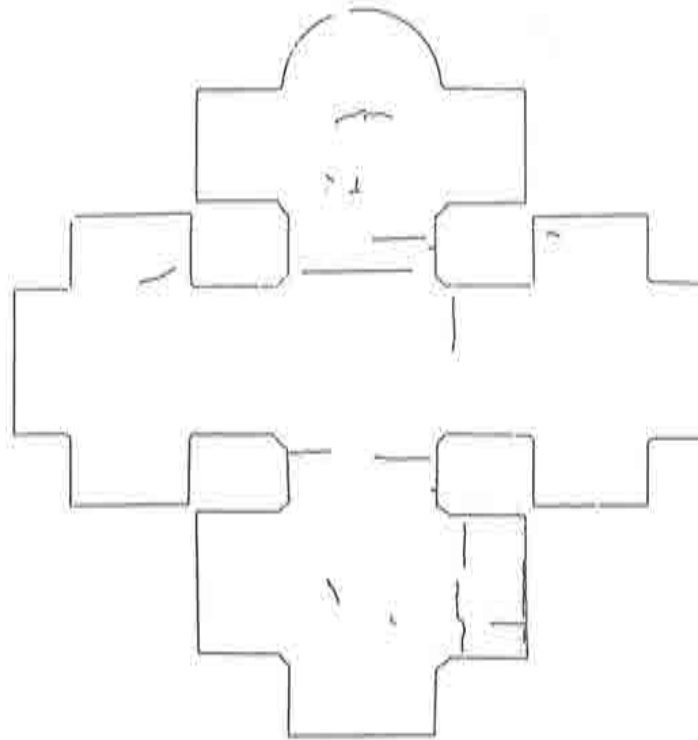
Planimetría de la cubierta con la localización de las fisuras principales encontradas.
